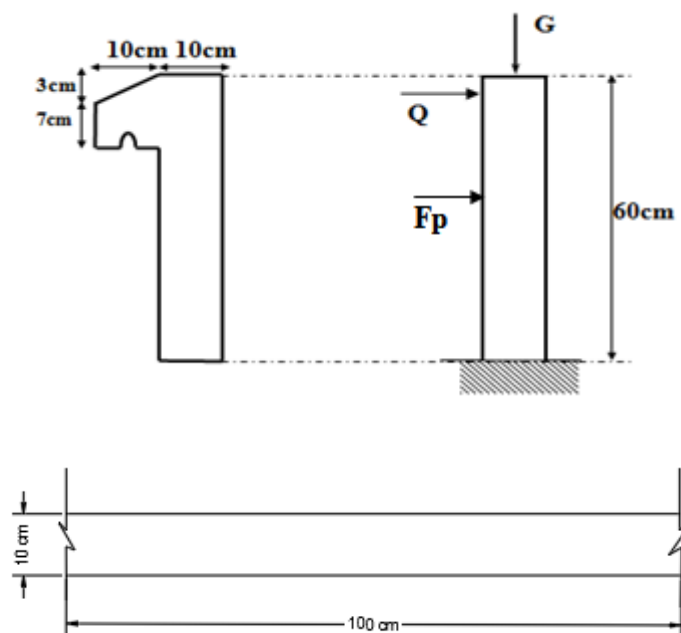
Coupe transversale et longitudinale de l'acrotère
